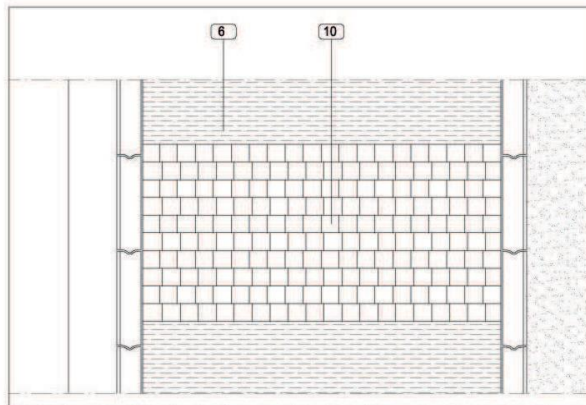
intervento di rifacimento di porzioni degradate della pavimentazione in asfalto pigmentato
